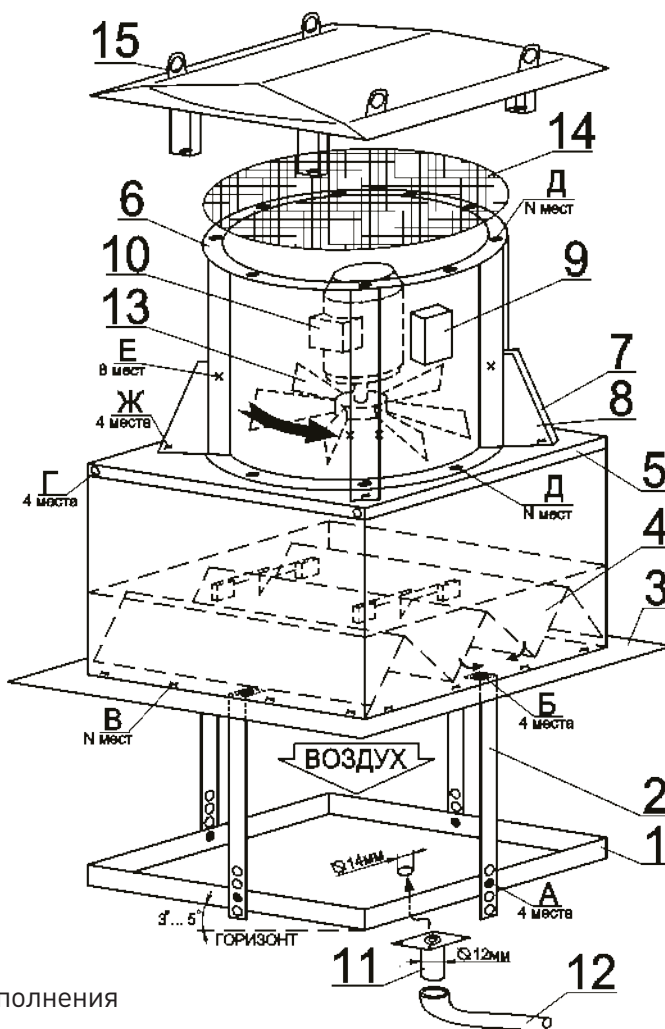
Схема монтажа вентилятора крышного исполнения
